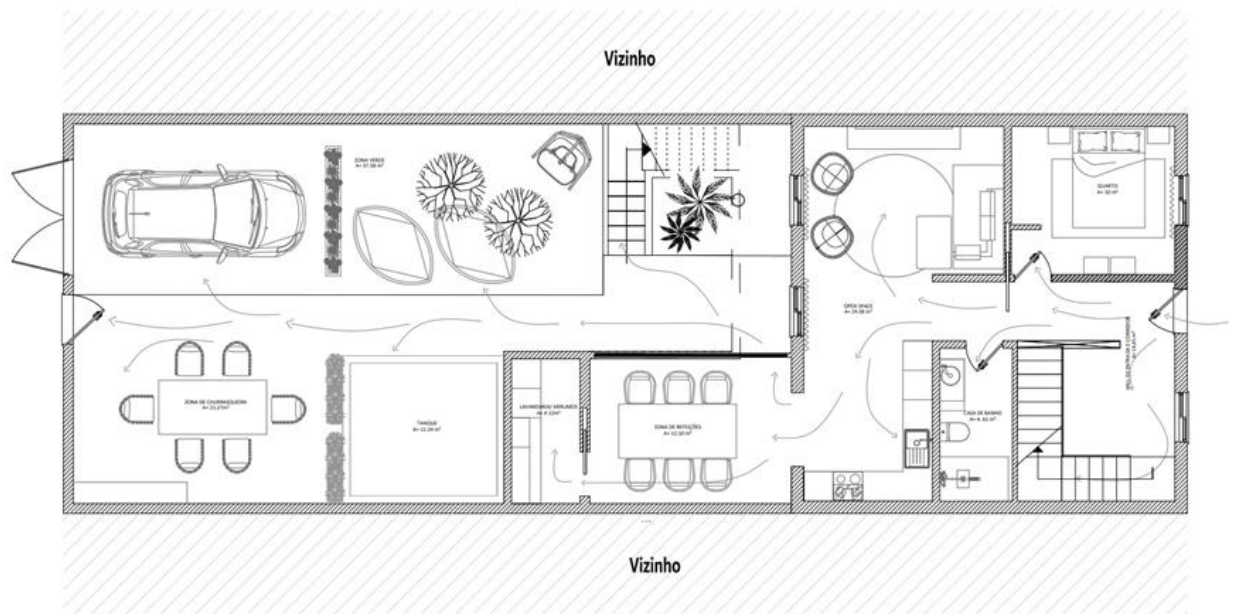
Plantas de Circulação e Zonamentos PISO R/C, Fonte: Autor
